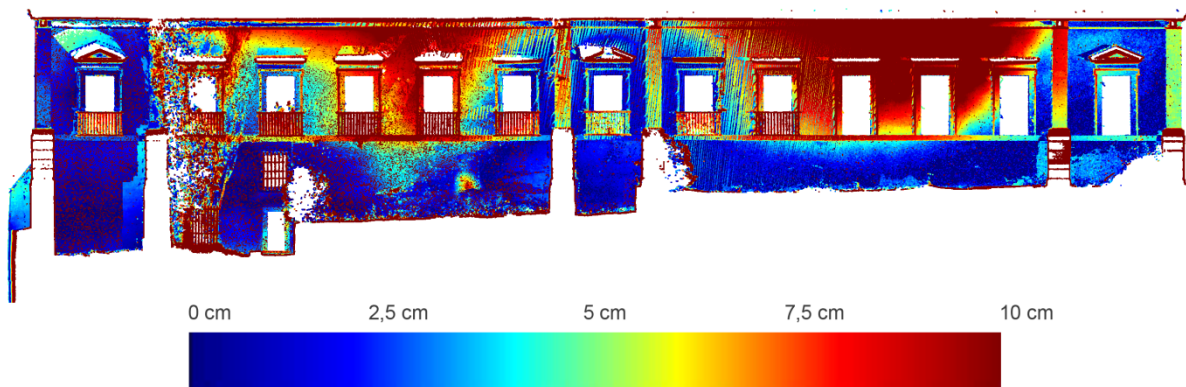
Inspeção à deformação da fachada Sul - A escala representa o desvio atual da fachada em relação ao seu plano inicial. (Escala de 10 cm)
